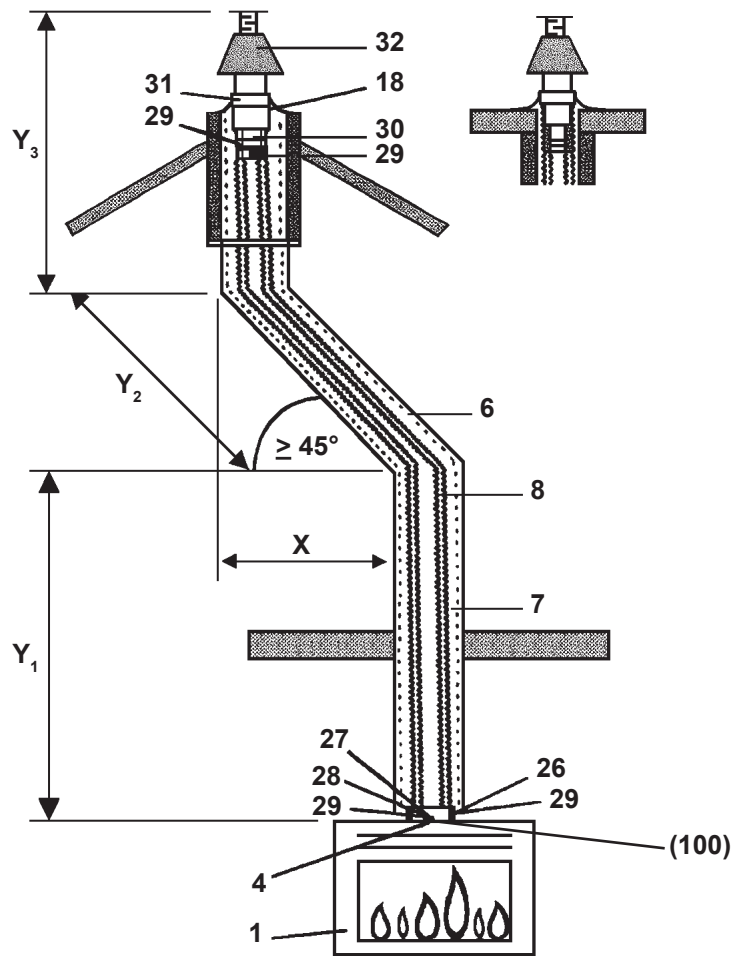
Sortie pour cheminée verticale en utilisant un conduit de fumée "fuite" existant ou si un conduit de fumée n'est pas présent (Flexible Ø100 mm / Ø150 mm)
